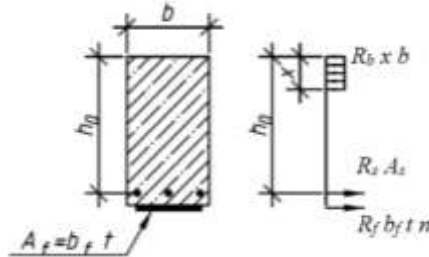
Расчетная схема усиленного внешним армированием нормального сечения
